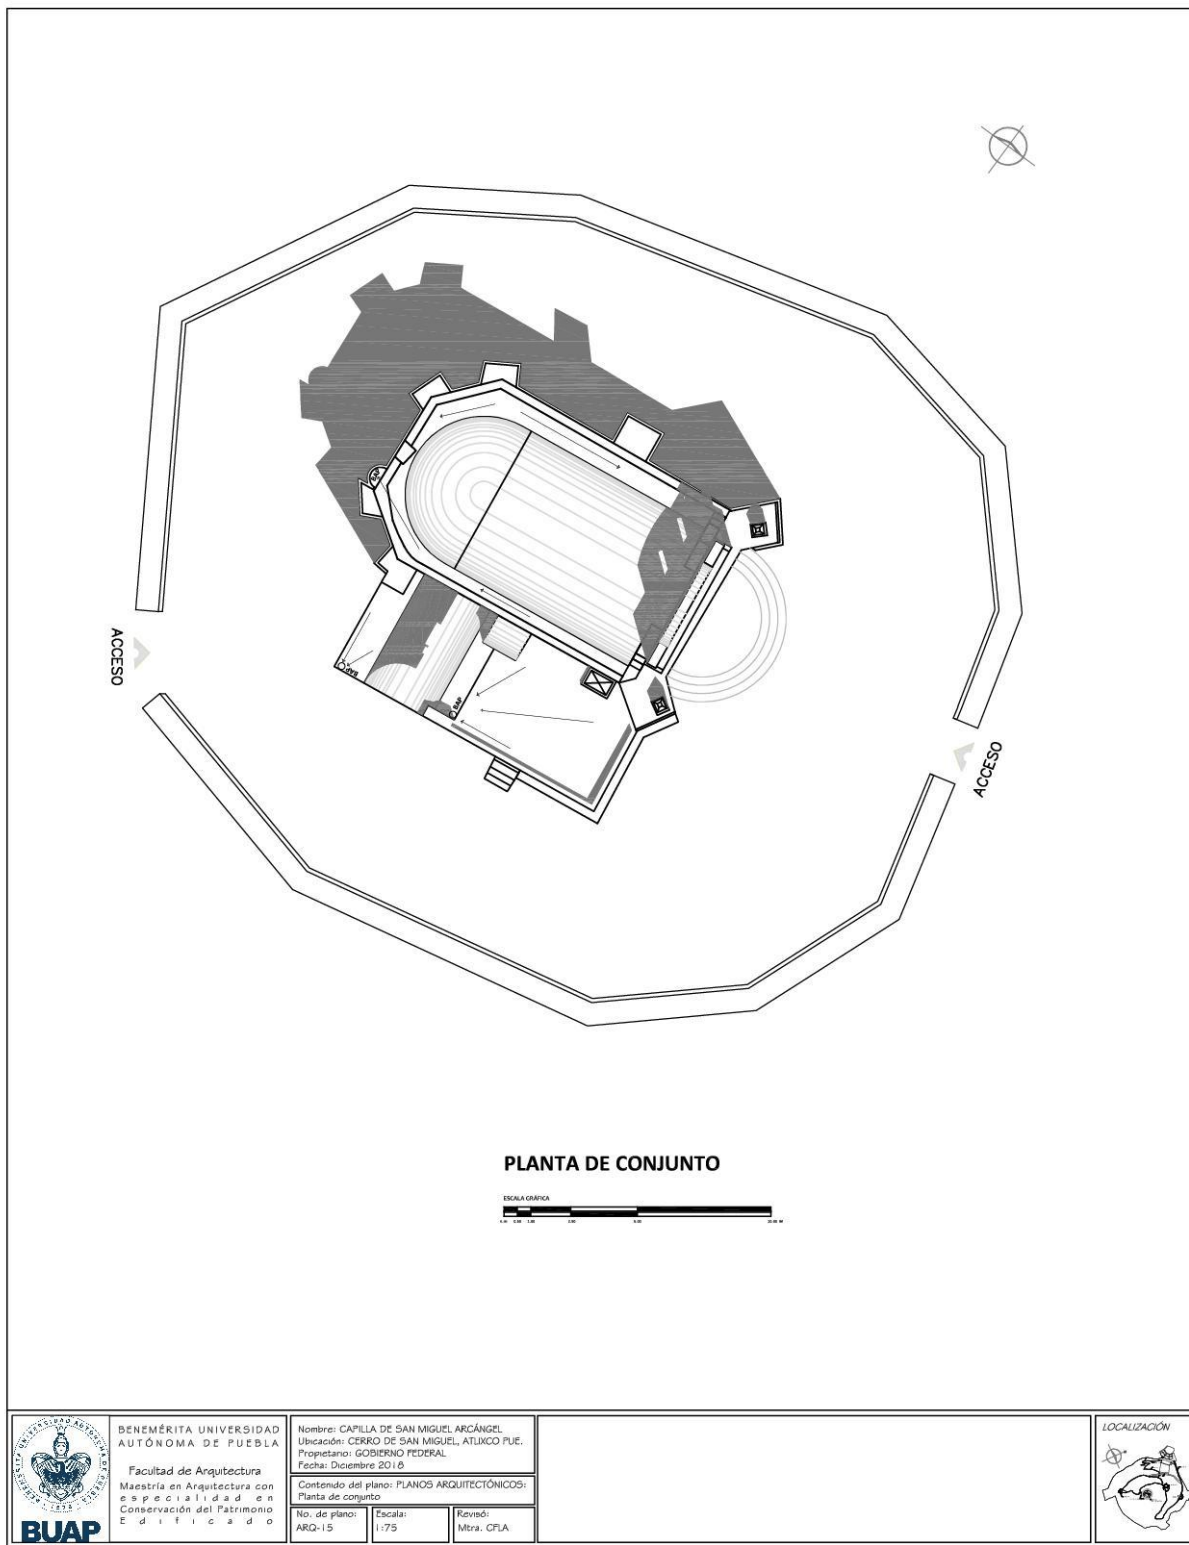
Planta de Conjunto de la Capilla de San Miguel.
